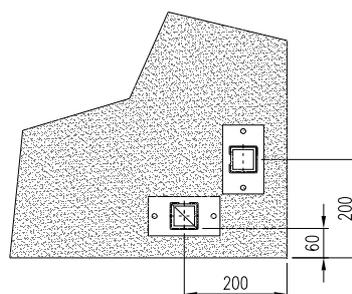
Draufsicht der Position der Pfosten für die horizontale Befestigung
